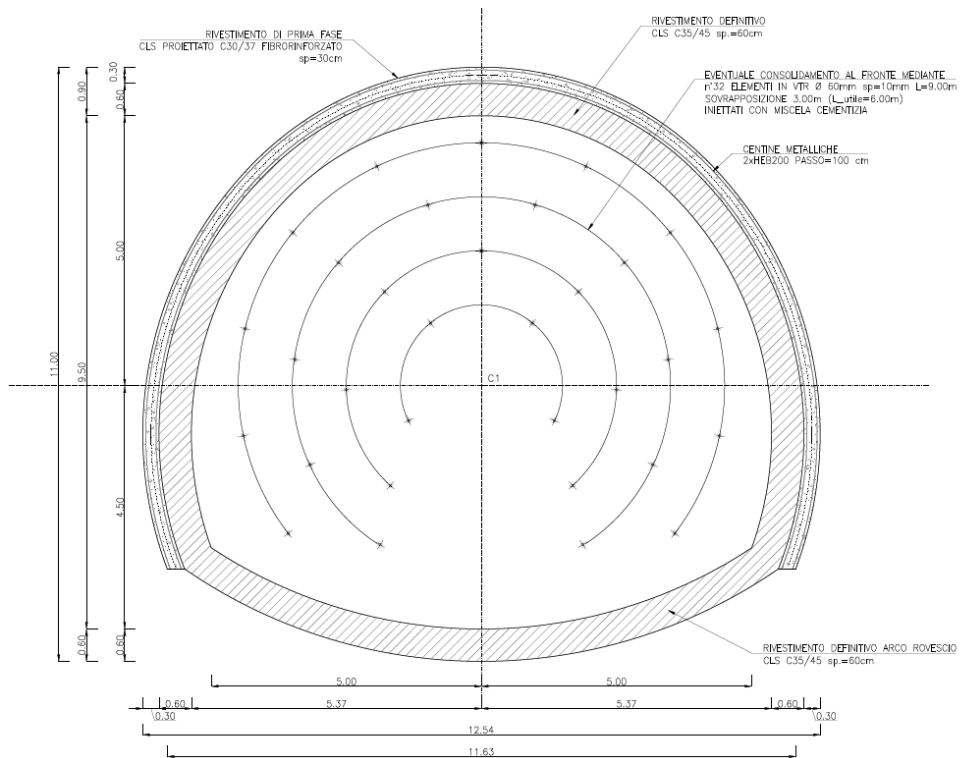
Sezione tipo D3: geometria del cavo e interventi di sostegno
